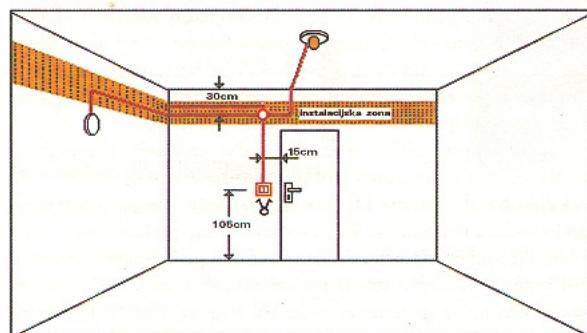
Plan instalacije za rasvetu sobe sa serijskom sklopkom
